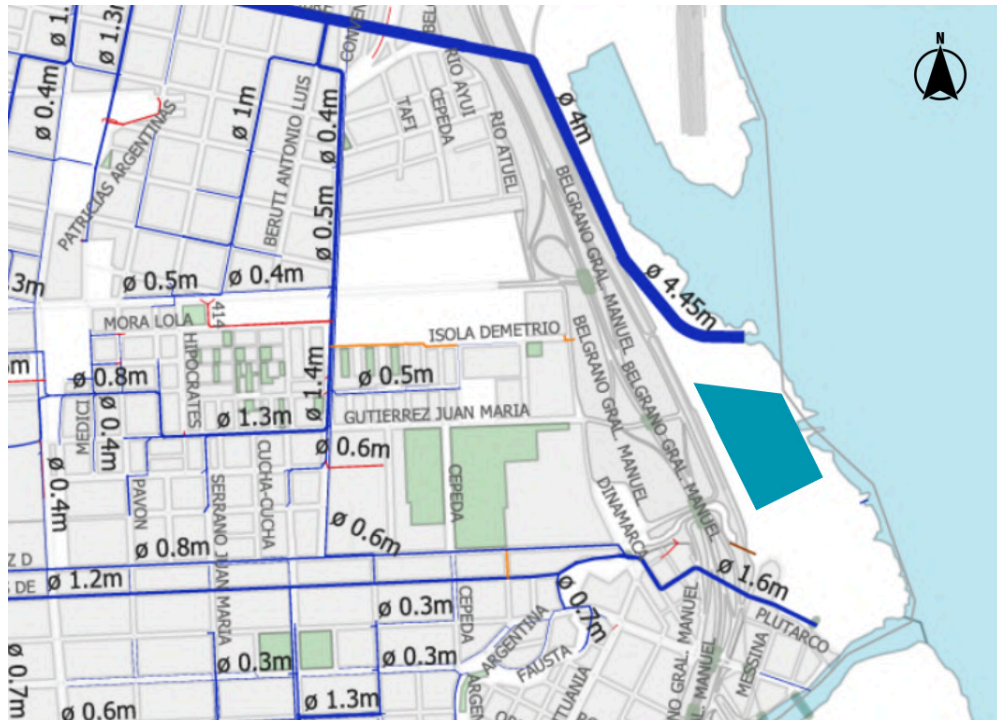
Implantación del terreno en el plano del Plan Director de desagües pluviales de la ciudad de Rosario. Fuente: Plan Integral de Desagües Pluviales de Rosario - Conductos existentes (azul) y/o proyectados.
